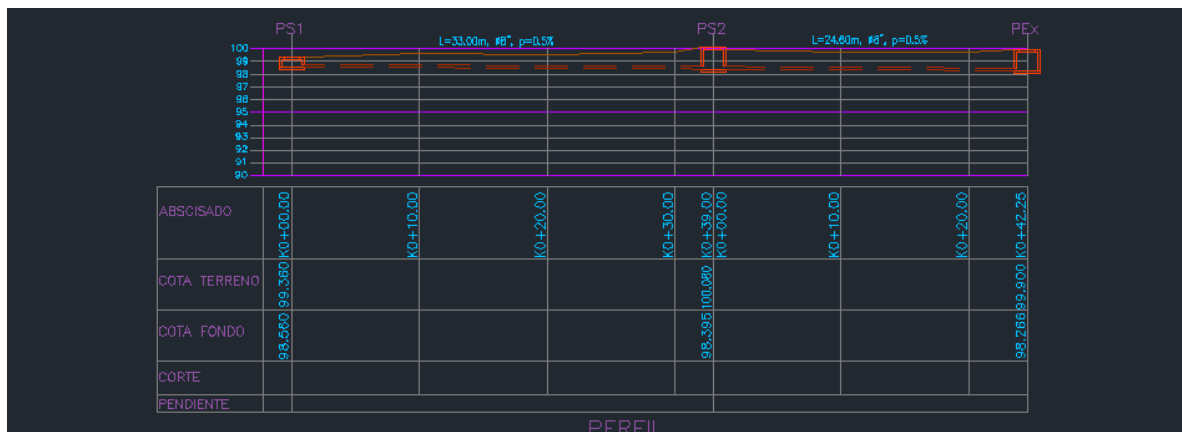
Captura Plano Autocad vista en perfil de los diseños constructivos. Barrios Nuevo horizonte
